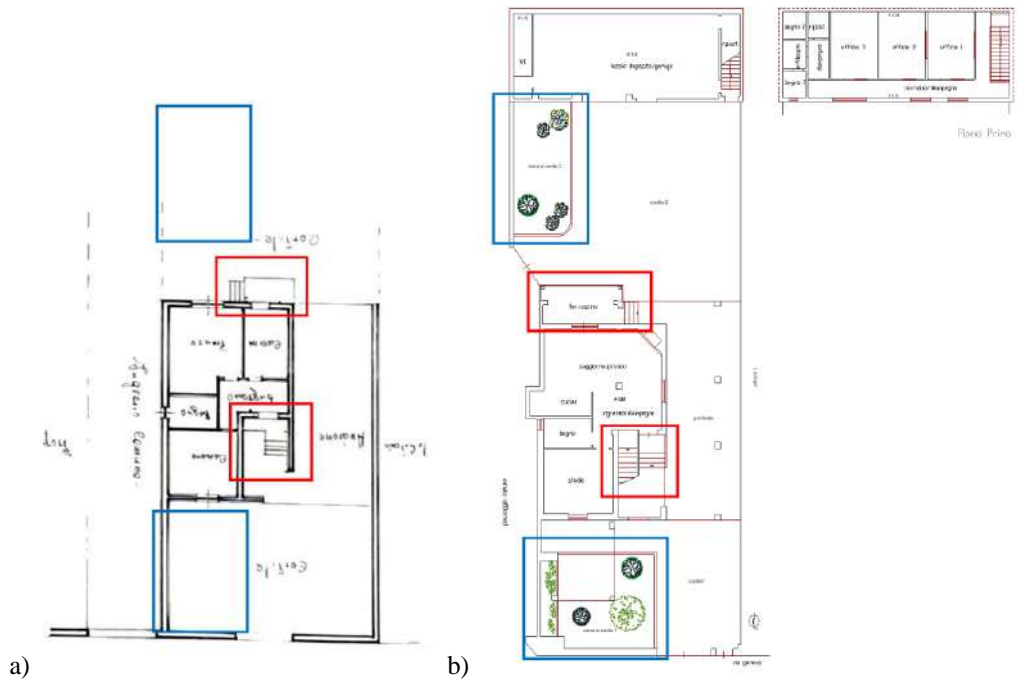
Difformità piano terra: a) Planimetria del titolo abilitativo; b) Planimetria stato di fatto
